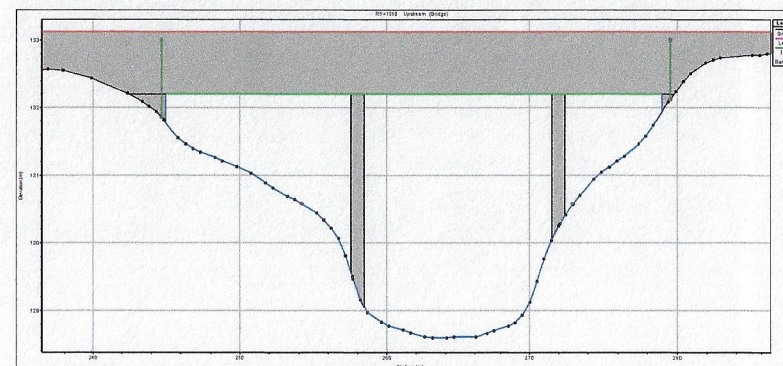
Vista desde aguas arriba del puente existente en la sección 1060 del modelo
